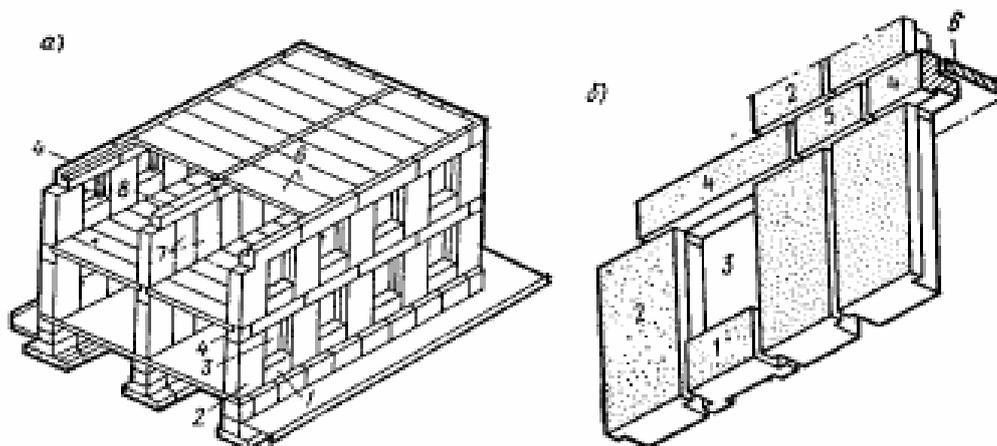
Фрагмент крупноблочного жилого дома с двухрядной разрезкой стены:
